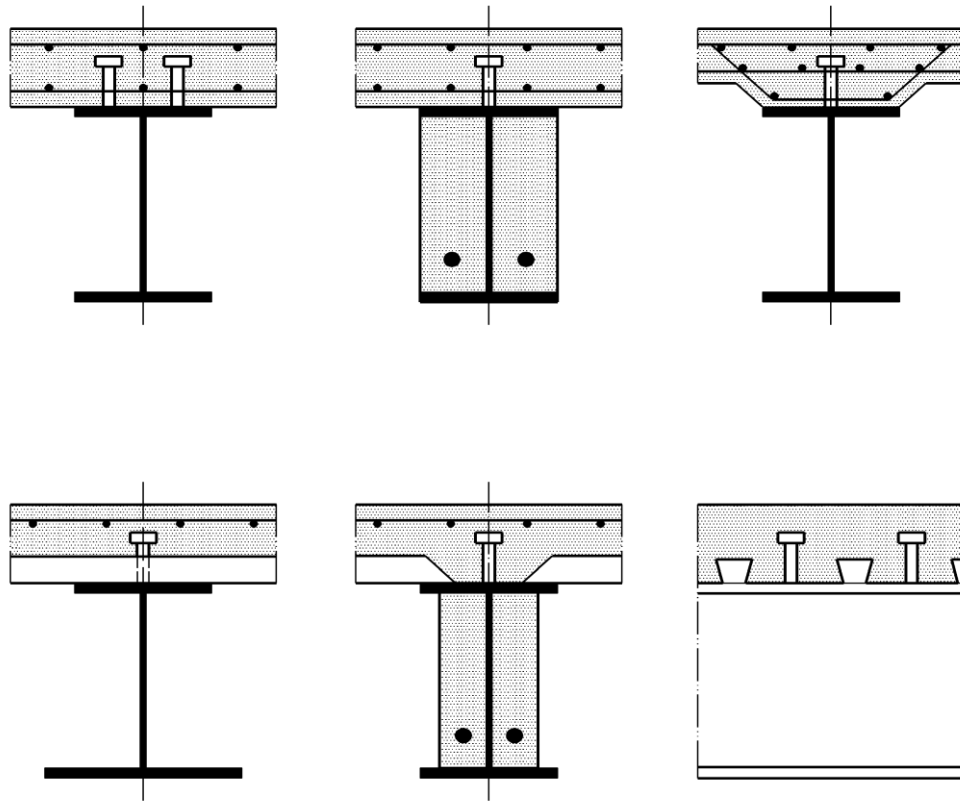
Déféréntes types des Sections de poutres mixtes [3]
